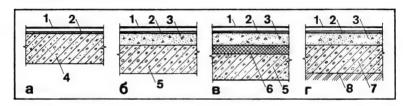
Устройство полов из линолеума: а — на ровной плите перекрытия; б — то же, на неровной; в — на перекрытии с теплонли звуконзоляционным слоем; г — на грунте; 1 — линолеум; 2 — клей или мастика; 3 — цементно-песчаная или бетонная стяжка; 4 — ровная плита перекрытия; 5 то же, неровная; 6 — тепло- или звукоизоляционный слой; 7 — бетонный подстилающий слой; 8 — грунт основания
